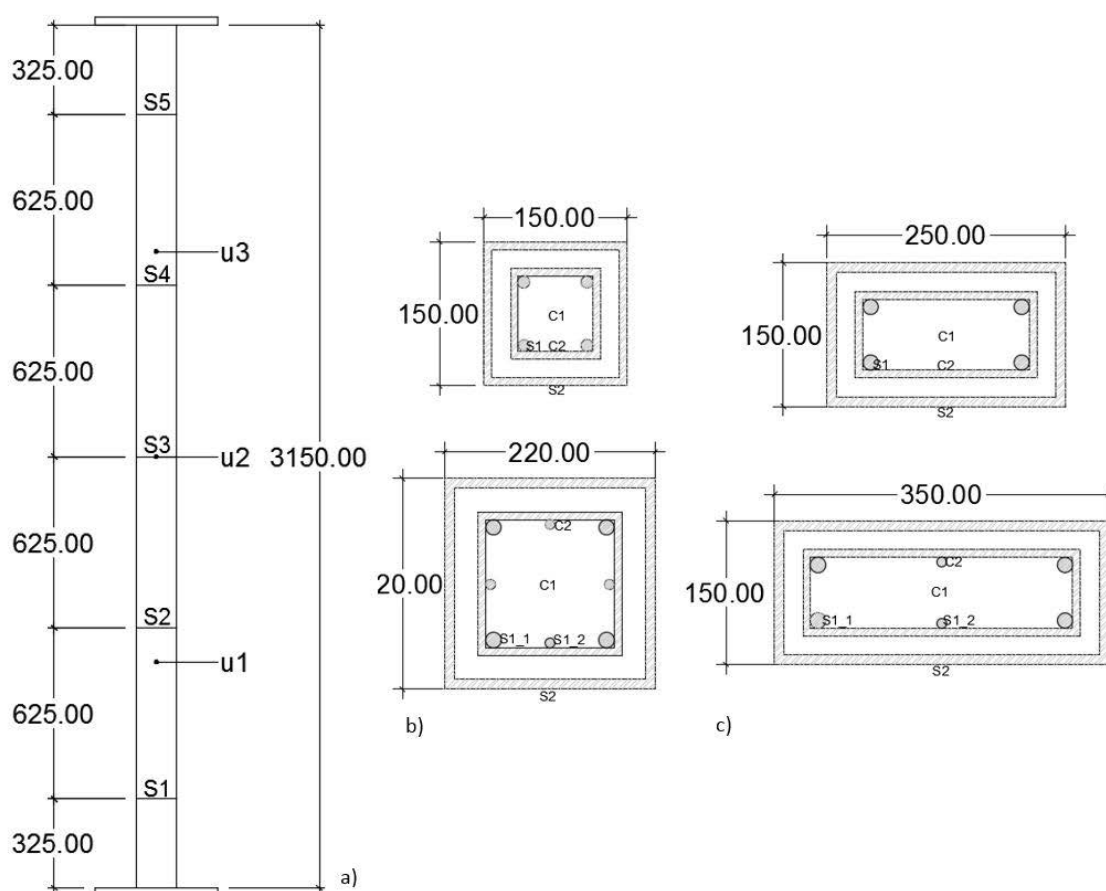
a) Localização das secções e dos transdutores ao longo da secção longitudinal e dos termopares ao longo da secção transversal de b) colunas quadradas e c) retangulares
